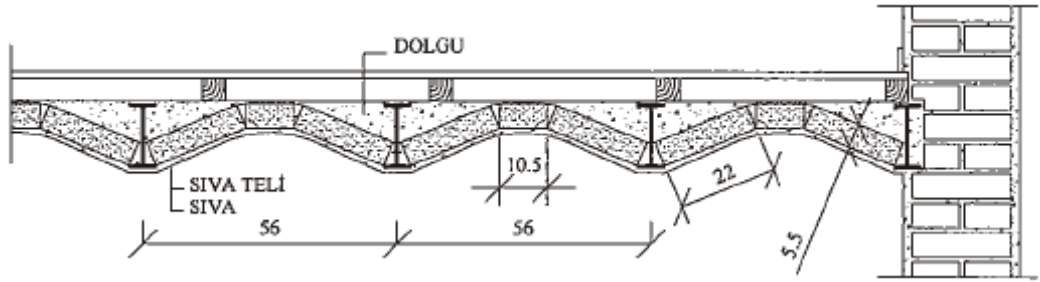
Ahşap Döşeme-Duvar Birleşim Planı
